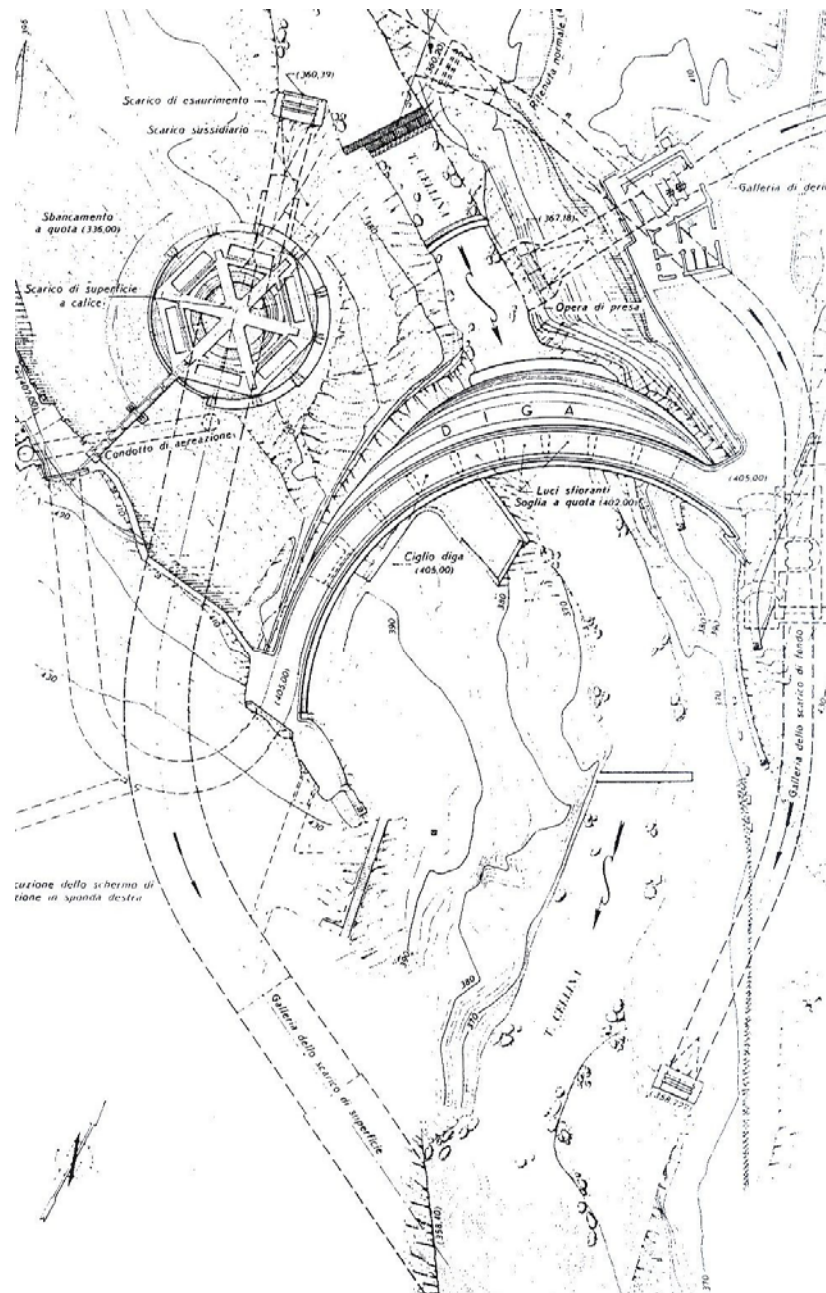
Planimetria della diga e delle attuali opere di scarico
